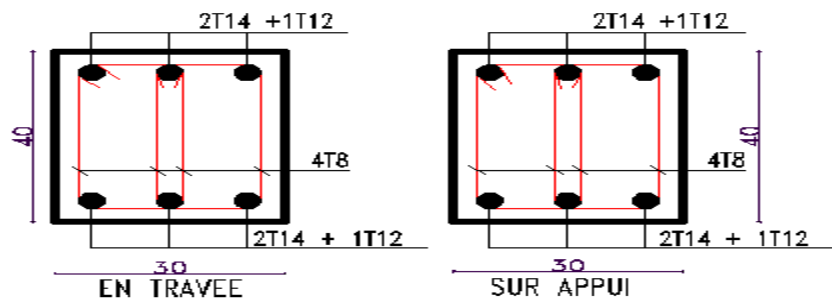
Schéma de ferrailage pour les poutres secondaires 30×40.
